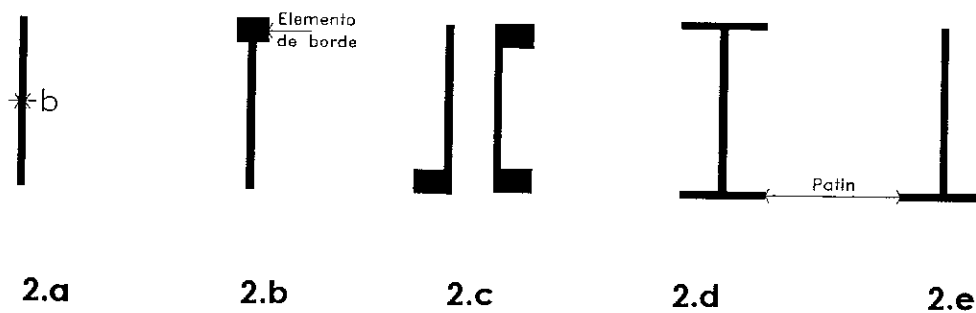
SECCIONES DE MURO -EN PLANTA -
